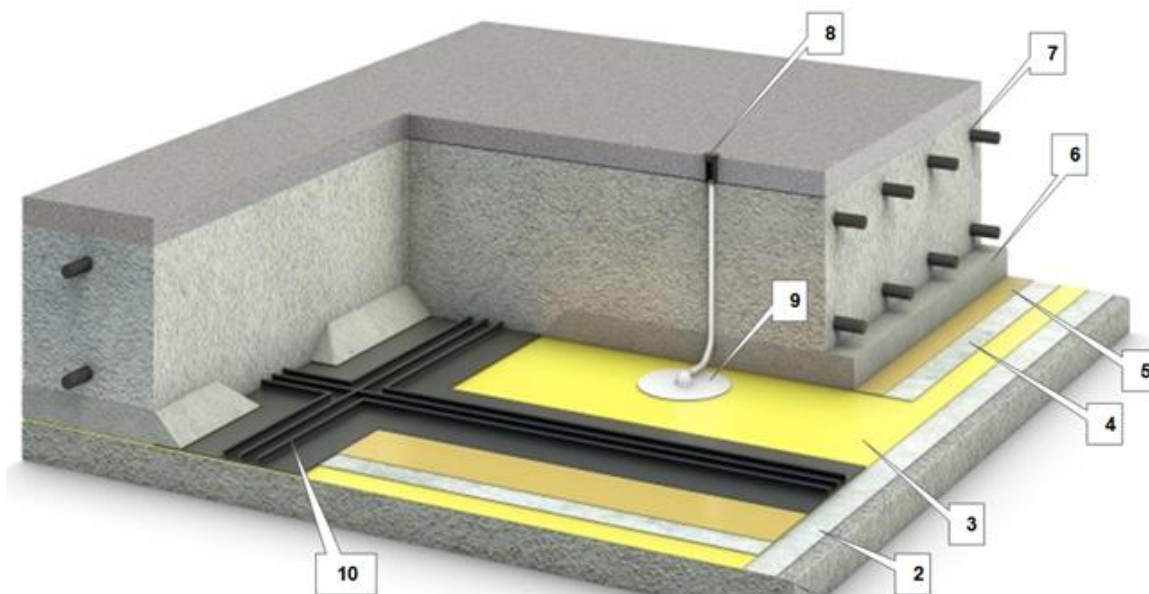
Конструкция гидроизоляционного покрытия транспортных тоннелей в лотковой зоне при открытом способе производства работ.
